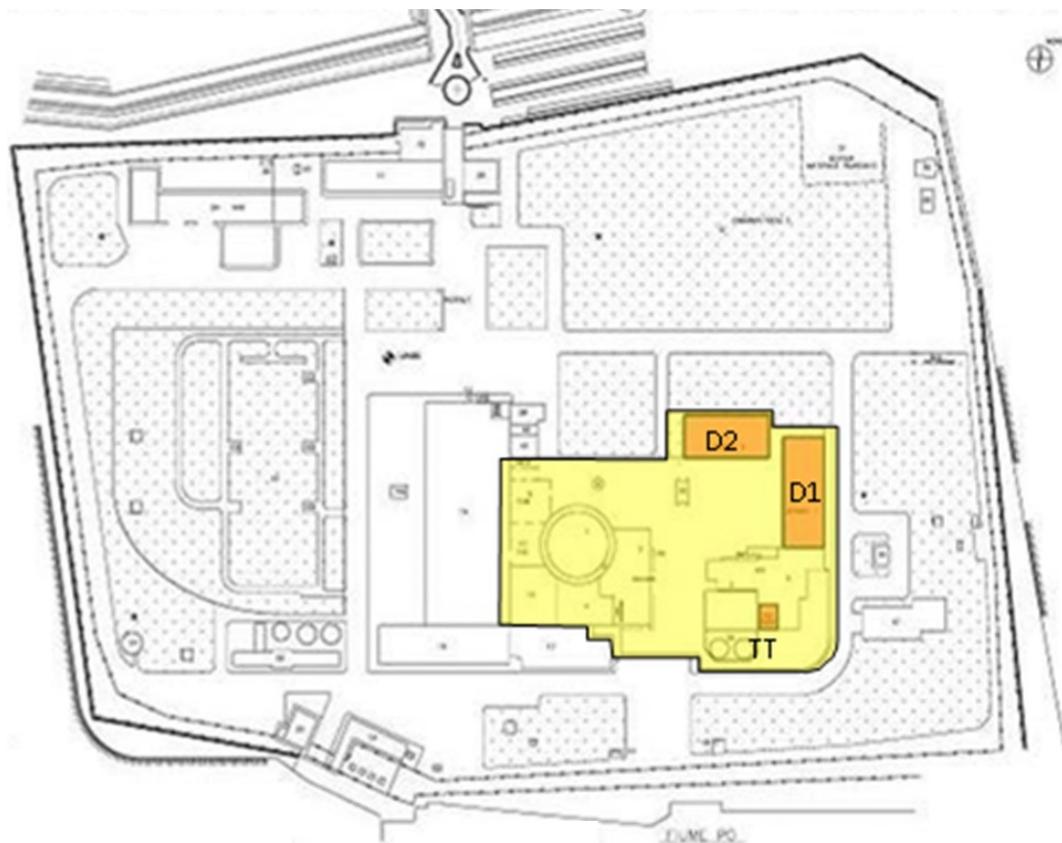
Planimetria generale di sito con indicazione della zona controllata (in giallo) e degli edifici da demolire e ricostruire
